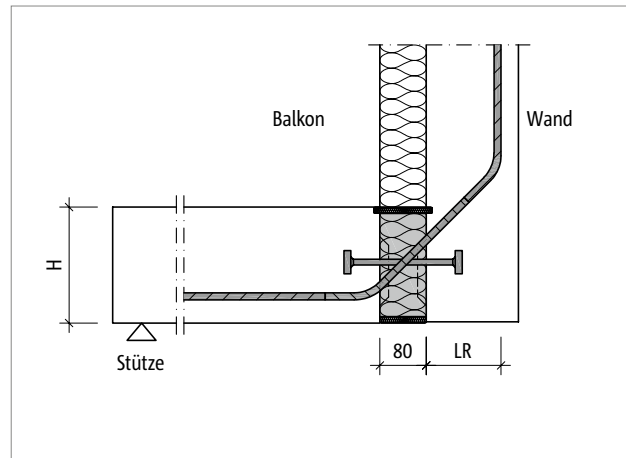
Schöck Isokorb® T Typ QP-WO: Wandanschluss nach oben bei Außendämmung
